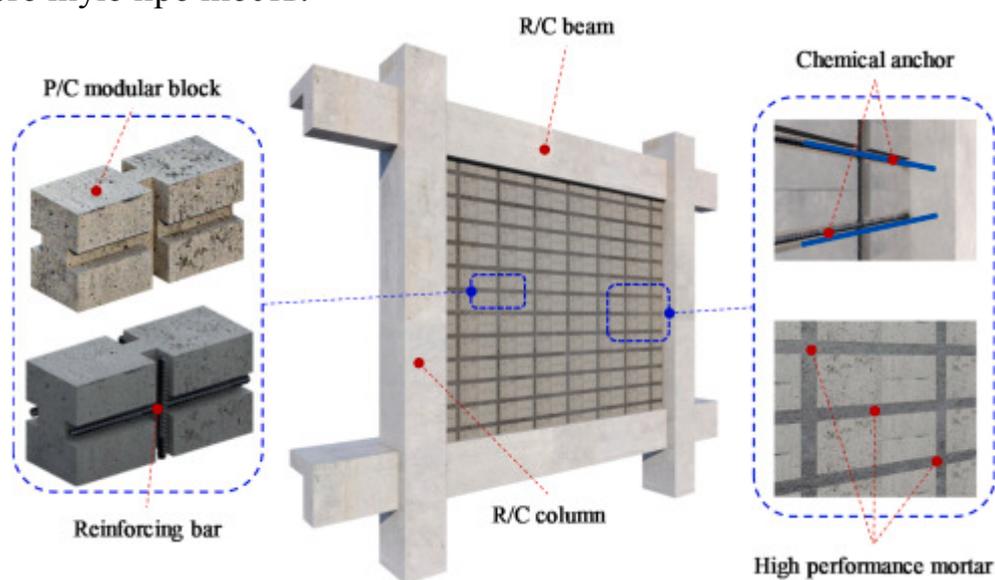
[1] Детали метода армирования каркаса сборной модульной блочной стены (PMBW). P/C: сборный бетон; RC: железобетон
